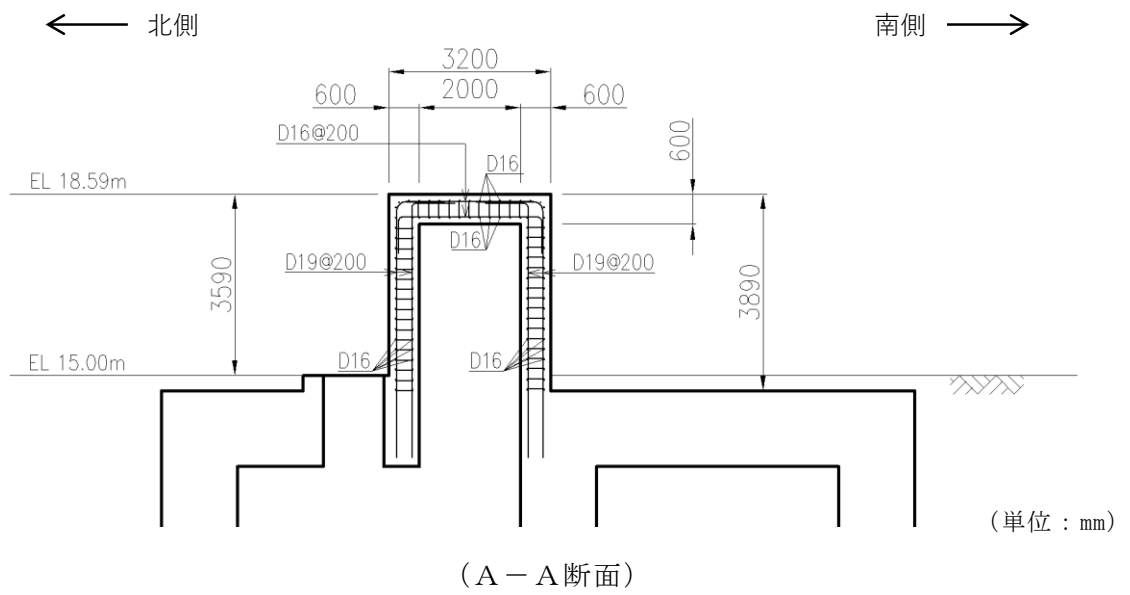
補助消火水槽（地上部）の概略配筋図
